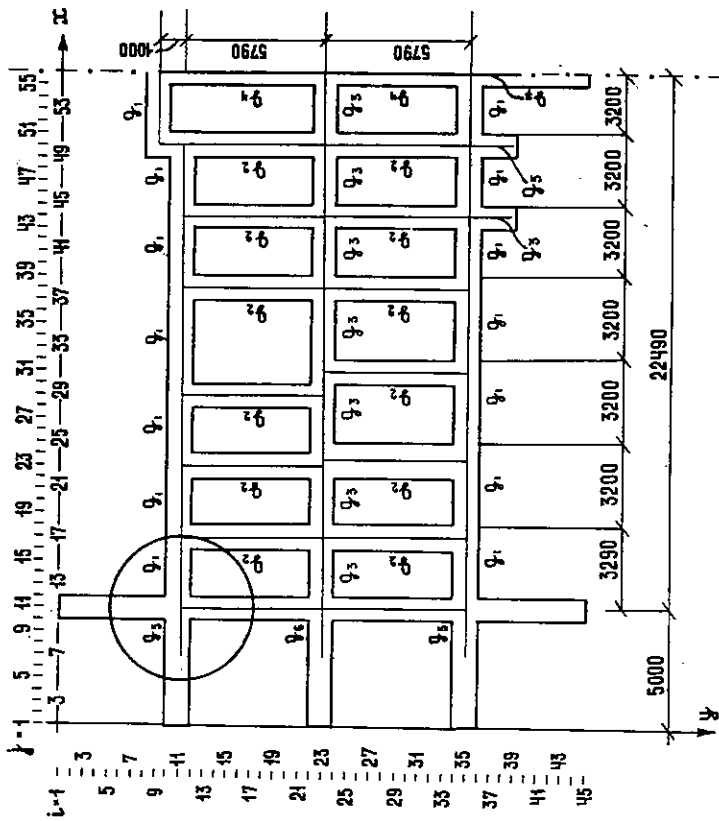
План перекрестно-ленточного фундамента 9-этажного крупнопанельного дома в г.Подольске
